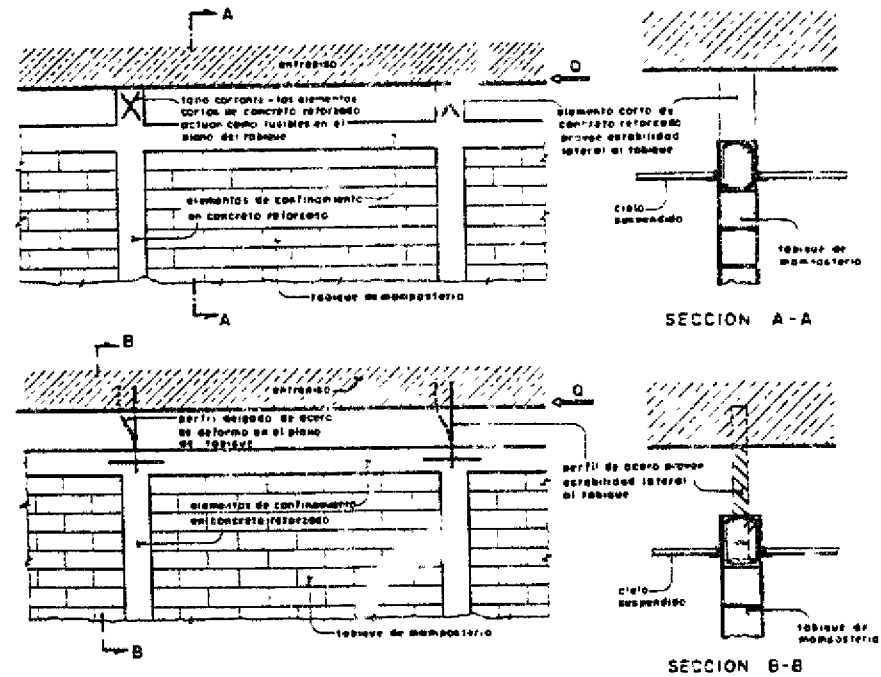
Detalles constructivos tendientes a separar los tabiques del entresijo superior y a proveer a la pared estabilidad lateral en sentido perpendicular a su plano.
